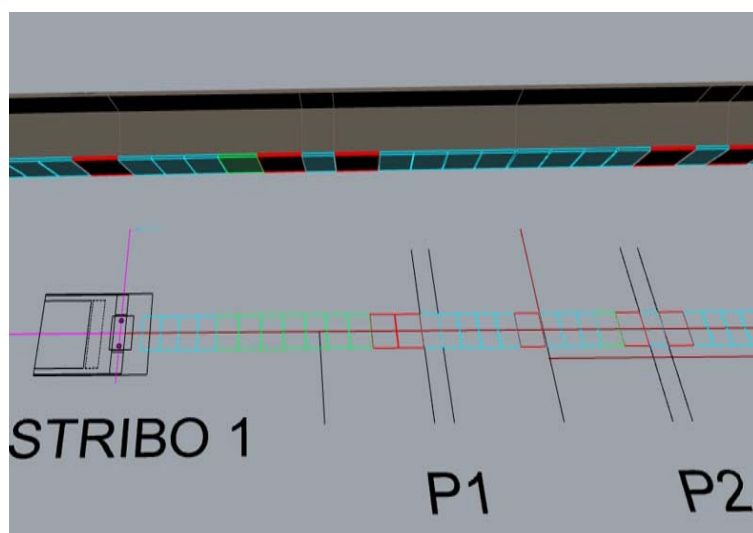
Output rutina 1, vista 3D y planta. Fuente: Propia (2024)
